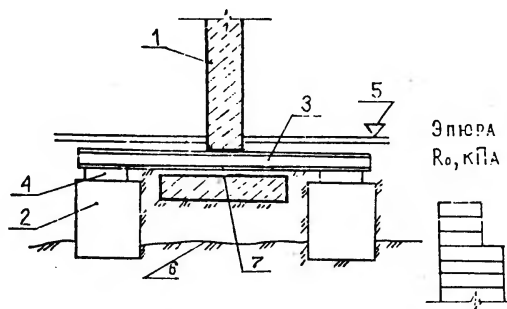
Подведение новых элементов с ослаблением фундаментной стены
